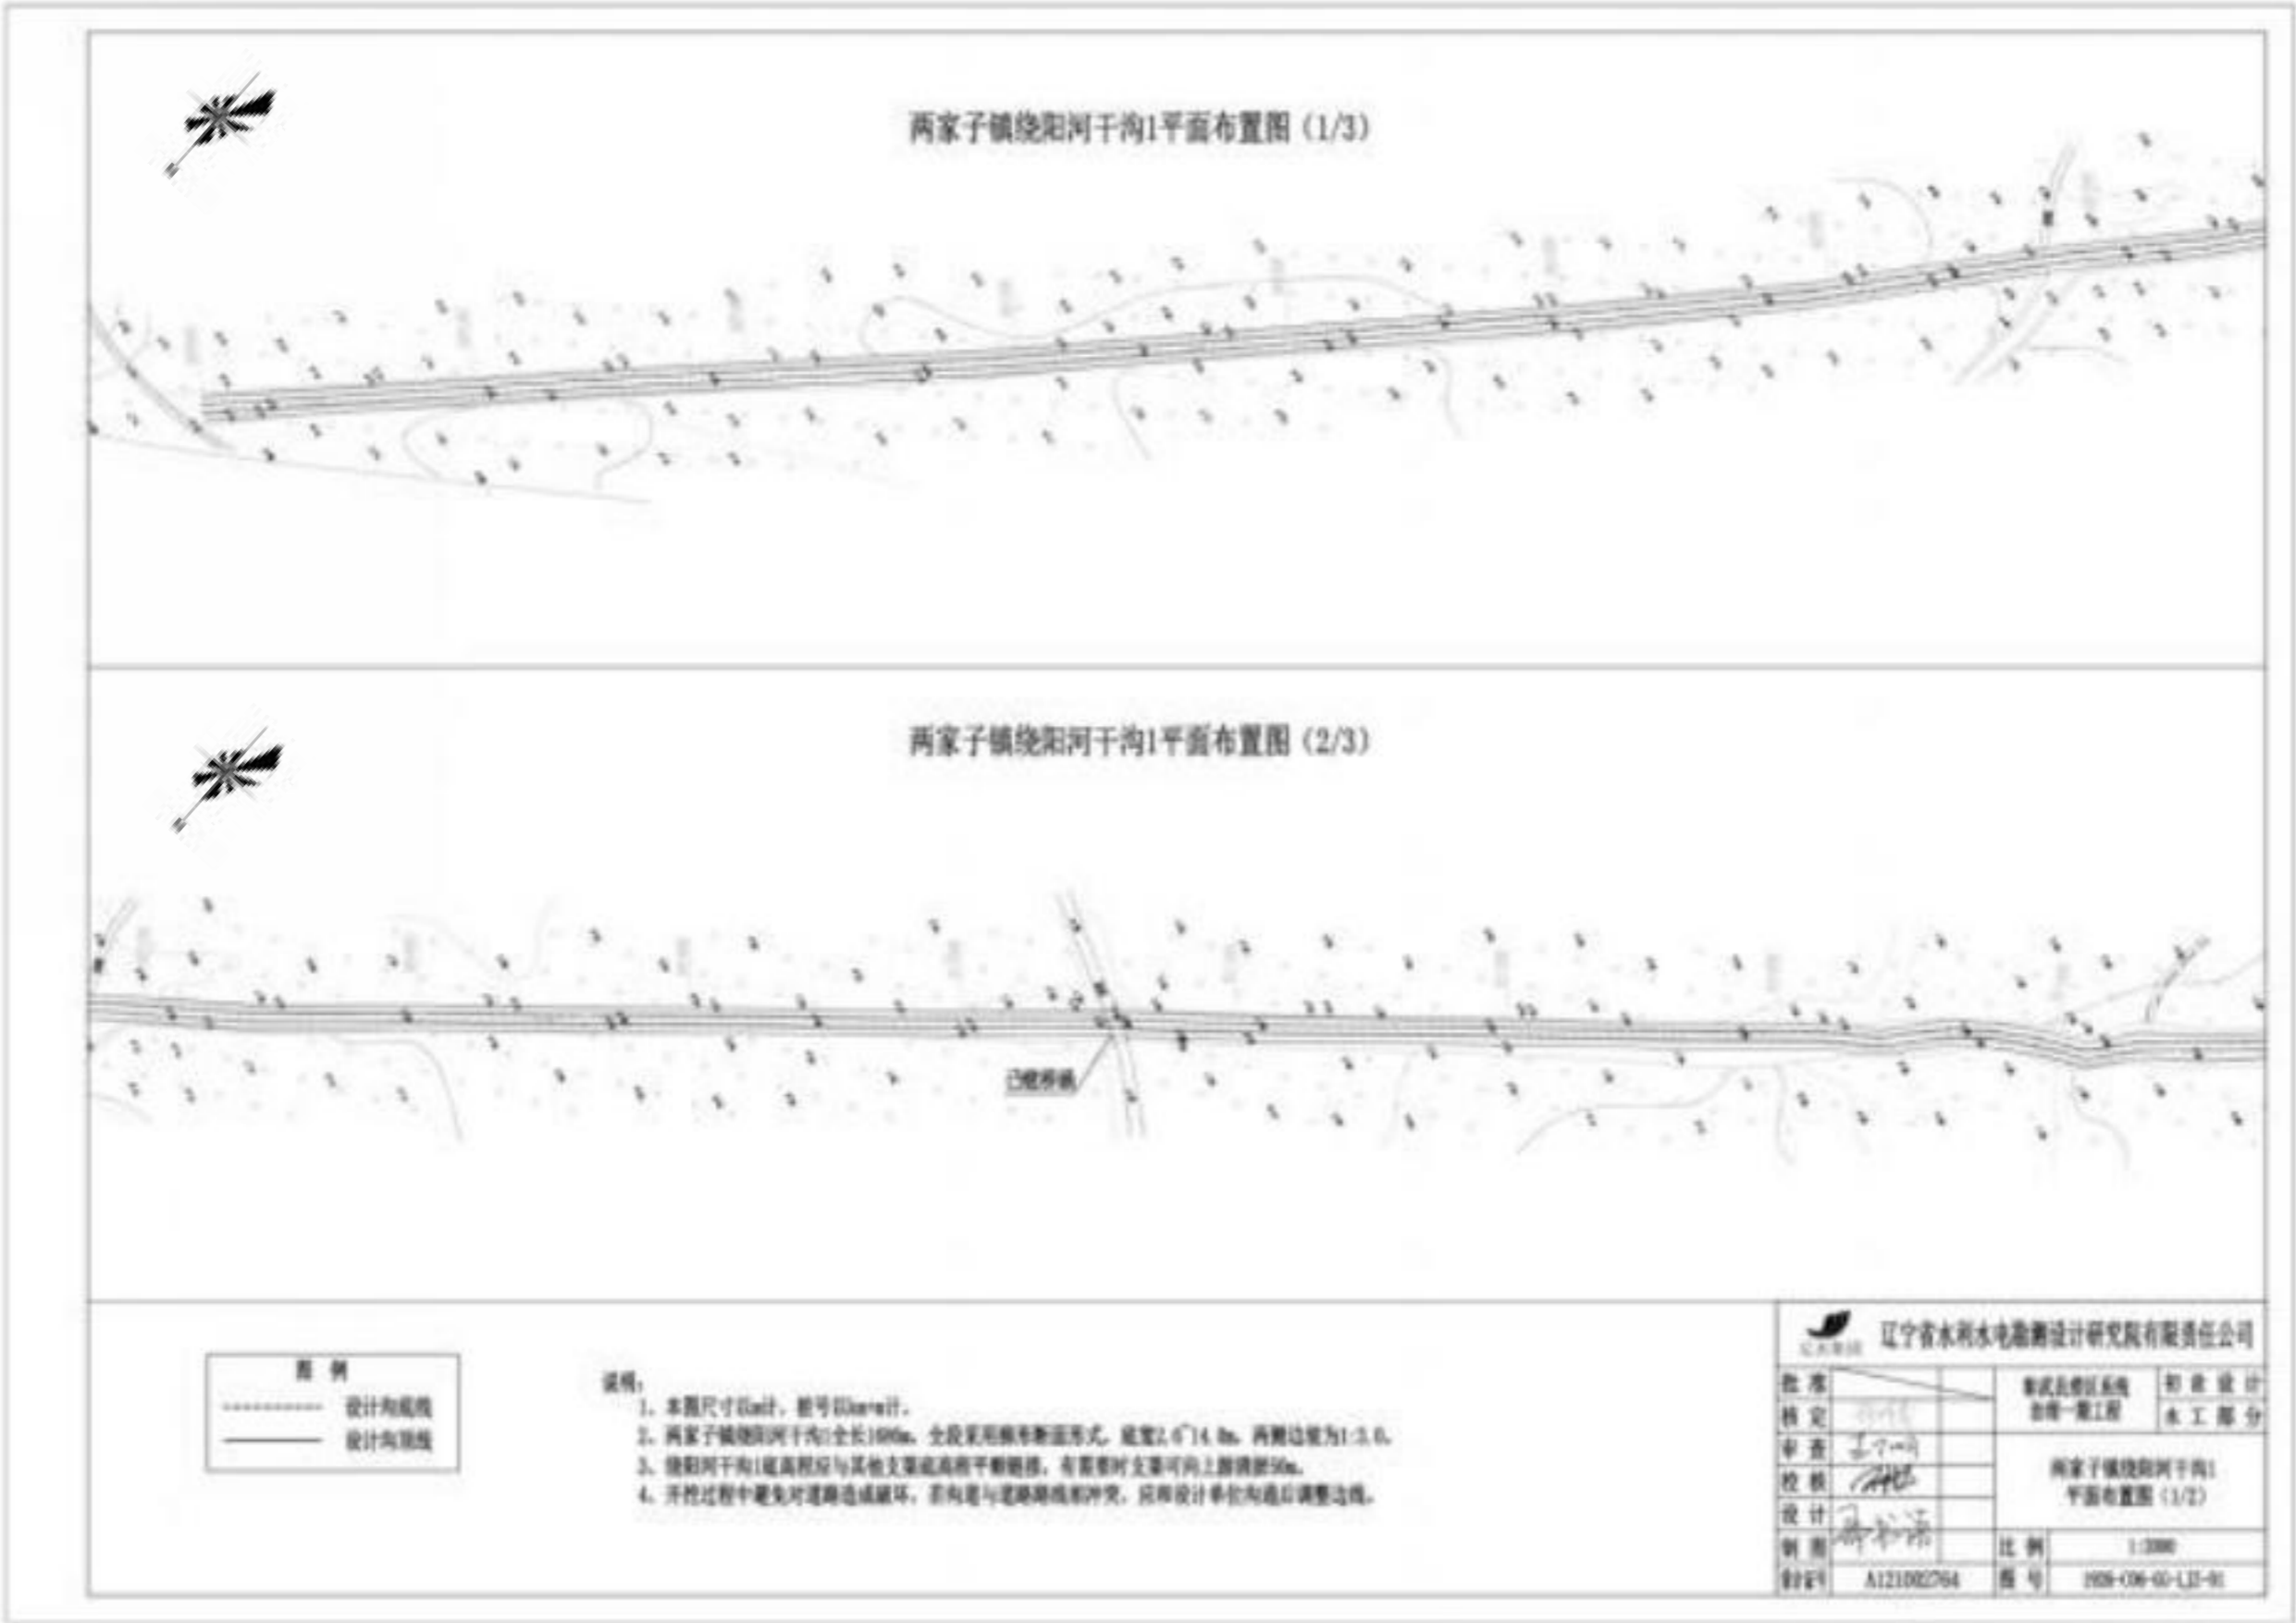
(1) 两家子镇绕阳河干沟 1 平面布置图
